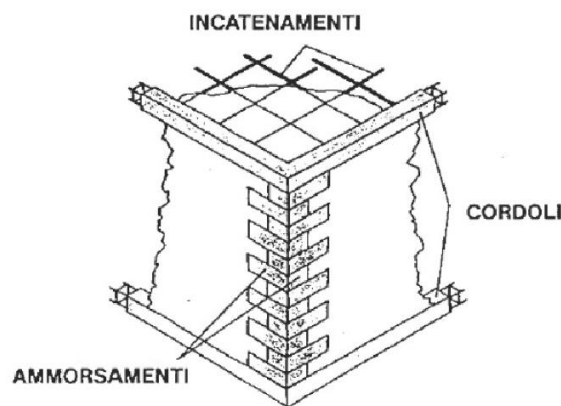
Collegamenti efficaci tra pareti ortogonali e tra pareti e orizzontamenti.
